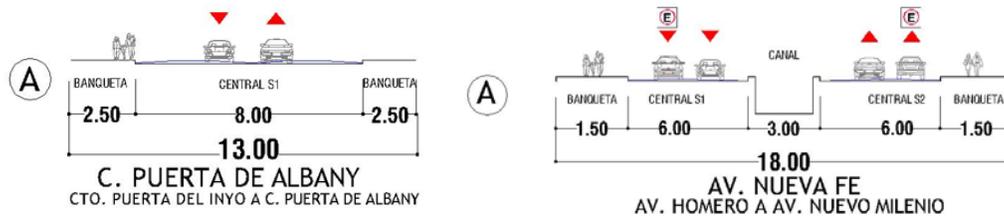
Av. Nueva Fe. y su sección actual. Fuente PDU 2040.
